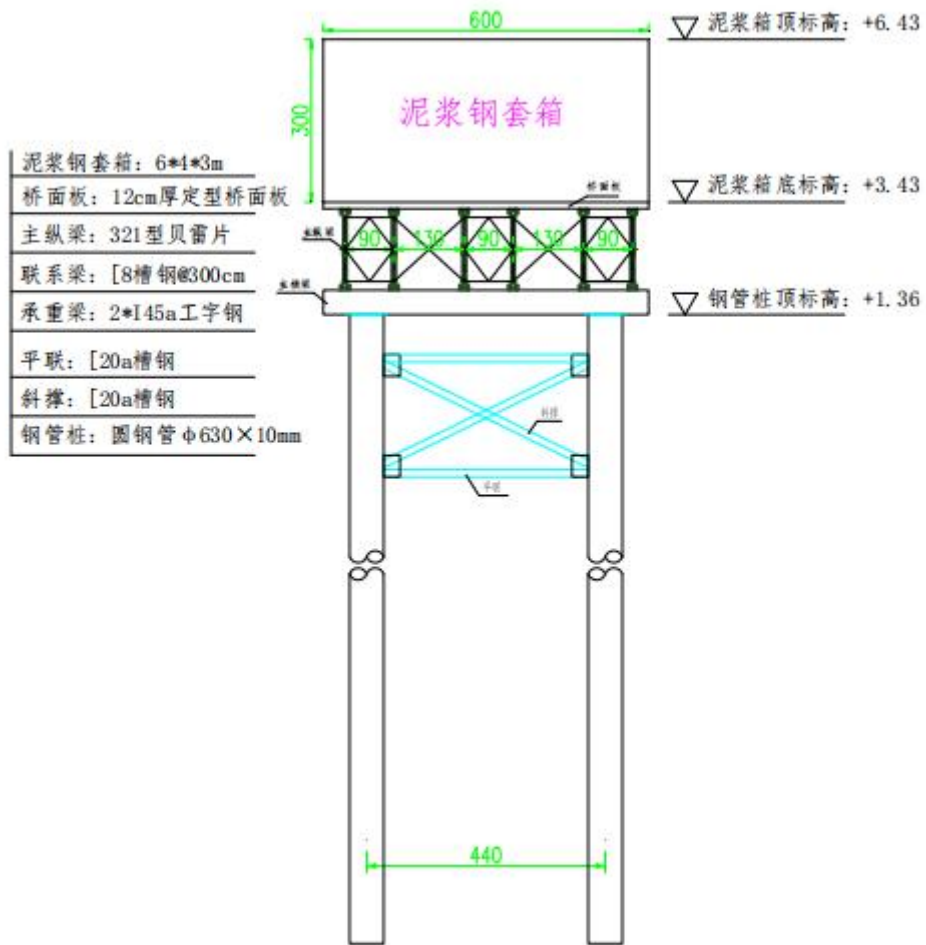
水上定型钢化钢结构泥浆池及沉淀池平台横断面图
